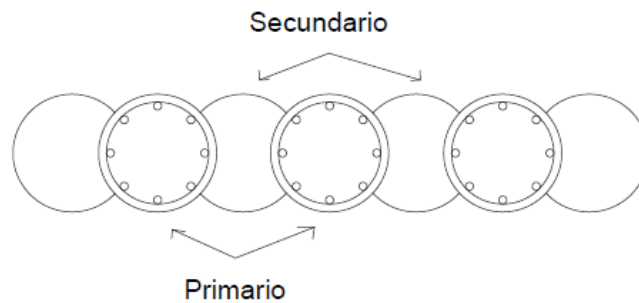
Vista en planta del proceso constructivo de pantalla de pilotes secantes (Muzás, 1980)
